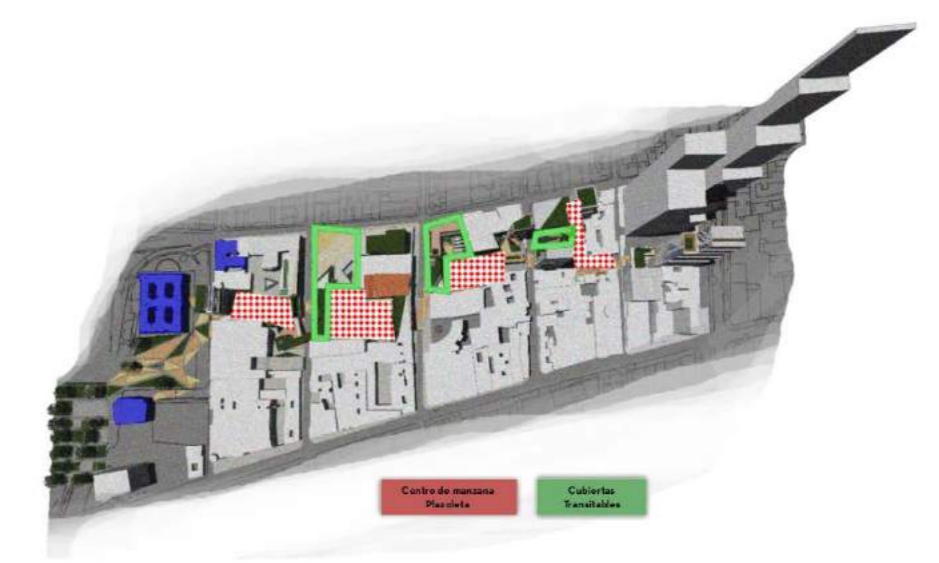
Planta de la propuesta. Fuente: Universidad Piloto de Colombia.
